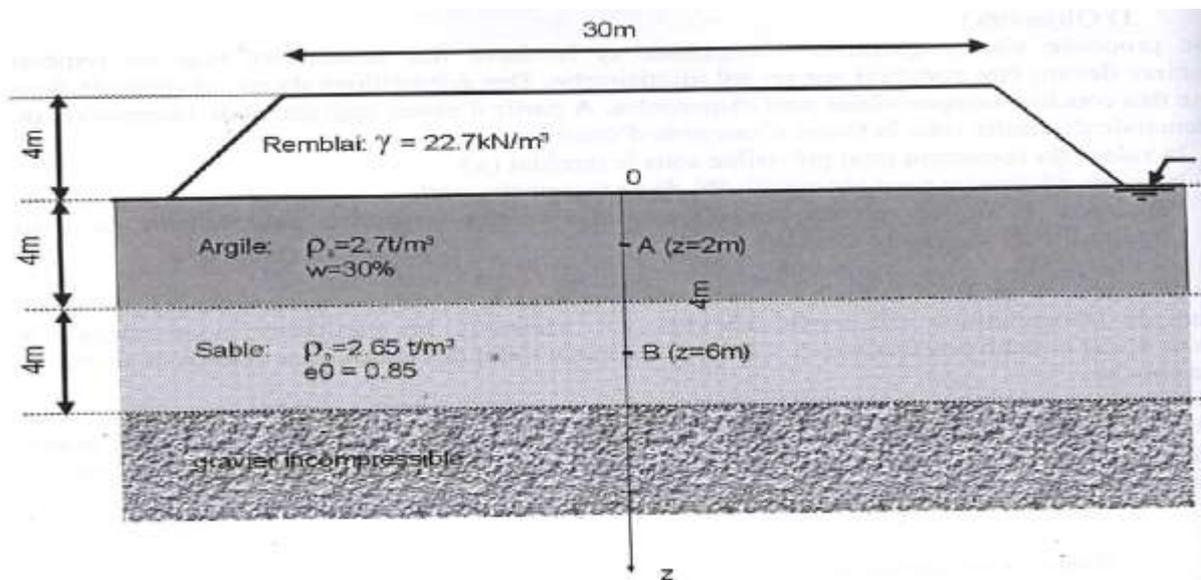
Schéma en coupe du remblai autoroutier et du sol porteur
